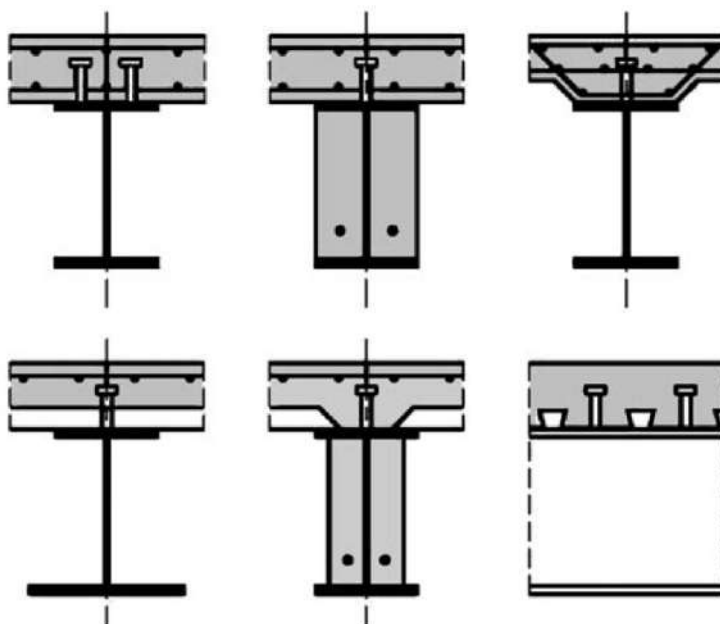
Типовые поперечные сечения сталежелезобетонных балок
